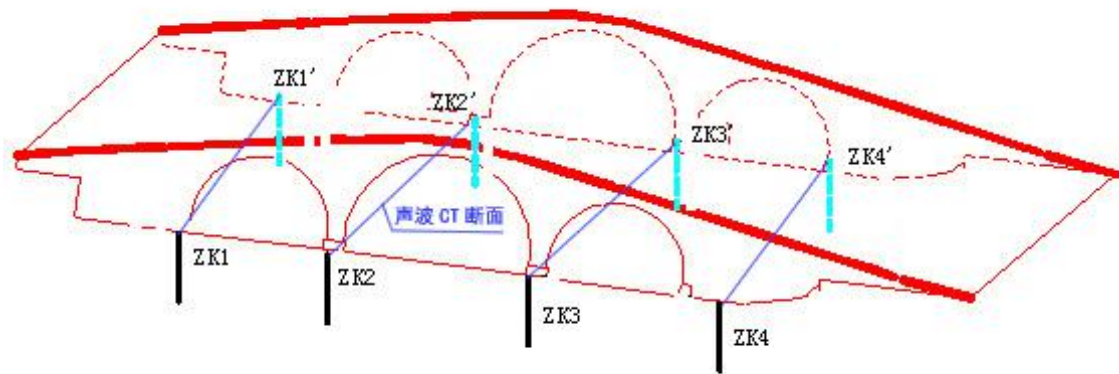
桥基木桩声波CT检测断面布置示意图
